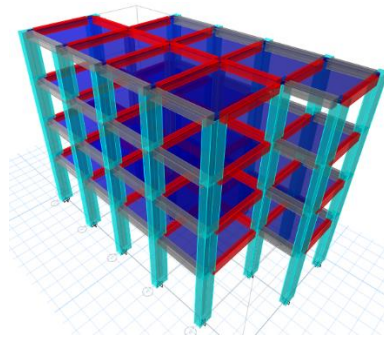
La ubicación de los elementos estructurales y su conectividad permiten construir un modelo estructural adecuado. Fuente: Elaboración propia.
